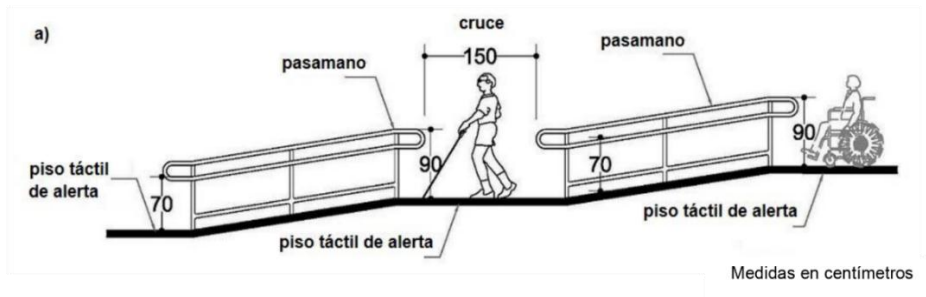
Vista en elevación frontal de rampa y de pasamanos central
